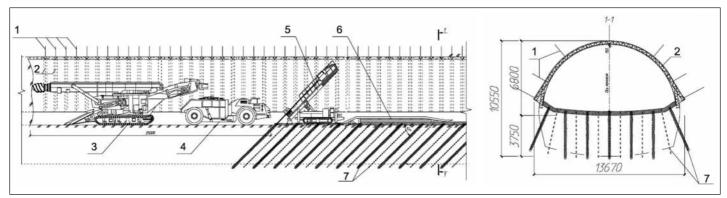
Технологическая схема проходки калотты автодорожного тоннеля: 1 – анкерная крепь кровли; 2 – арматурные арки, омоноличенные набрызг-бетоном; 3 – проходческий комбайн; 4 – автосамосвал MoA3; 5 – буровая установка; 6 – передвижной мост; 7 – железобетонные анкеры
